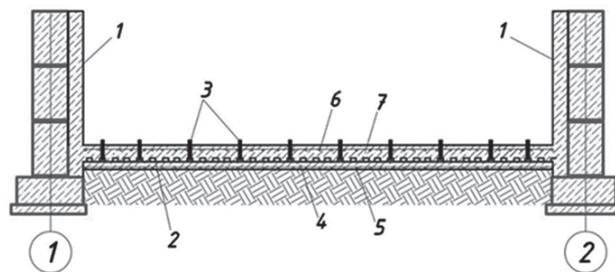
Подведение фундаментной плиты с несъемной опалубкой:
